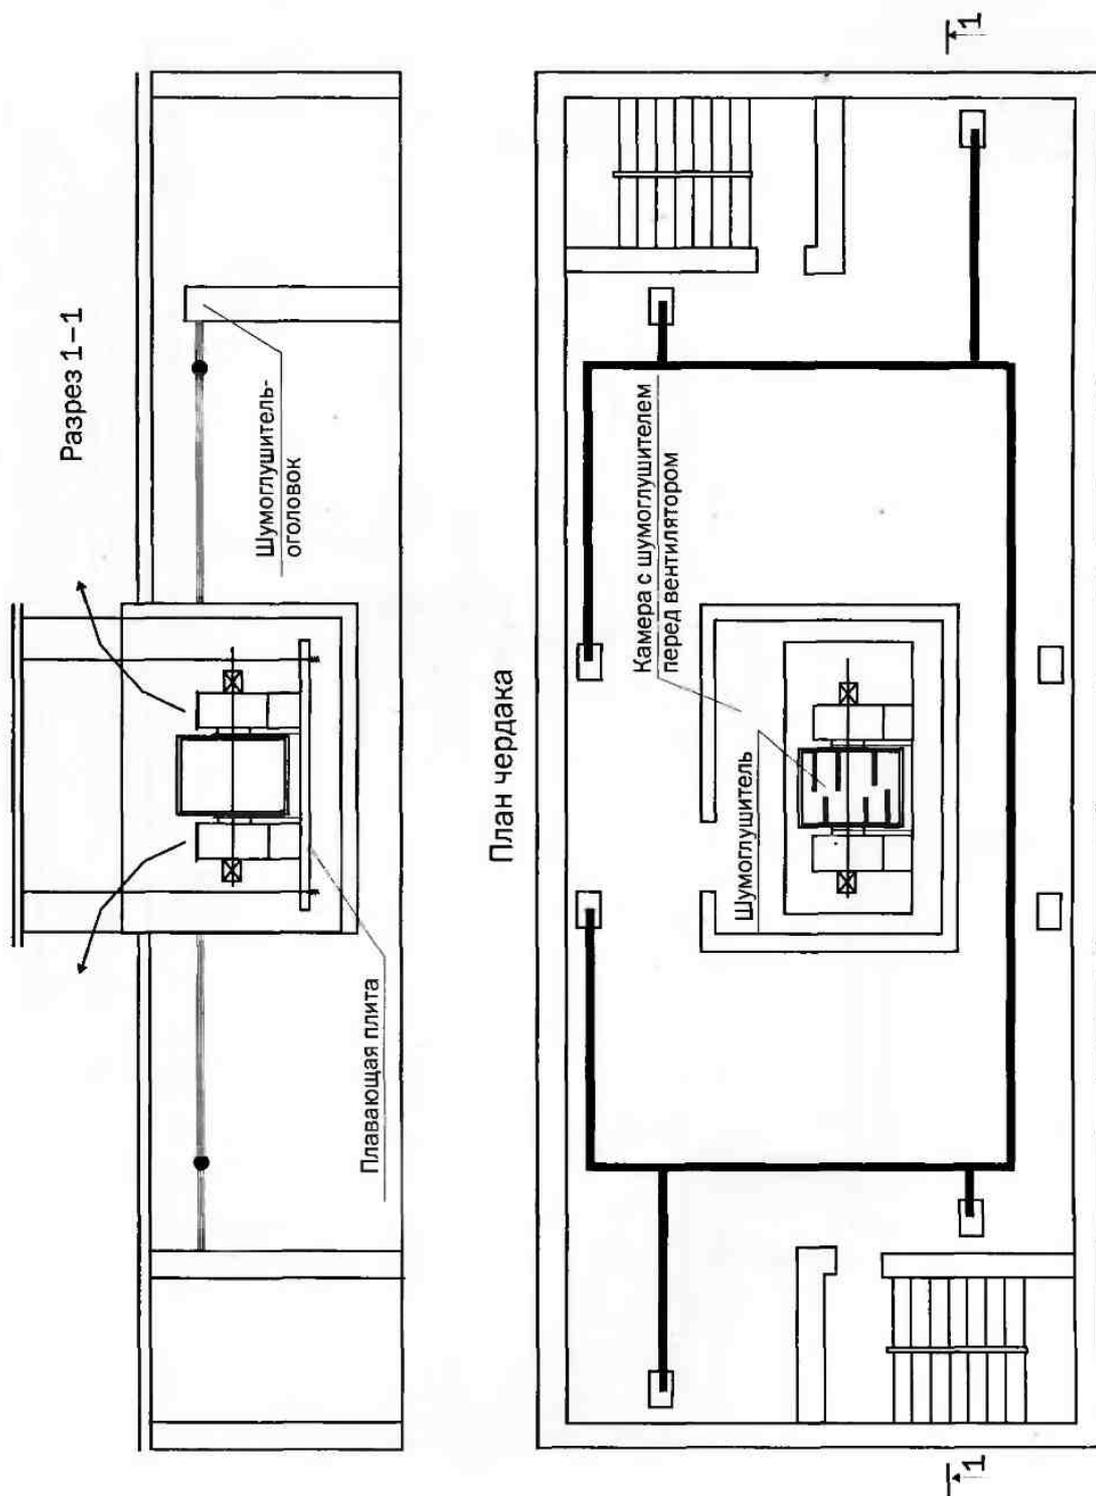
Схема размещения вентиляционных каналов и оборудования на чердаке при устройстве центральной механической вытяжной вентиляции
